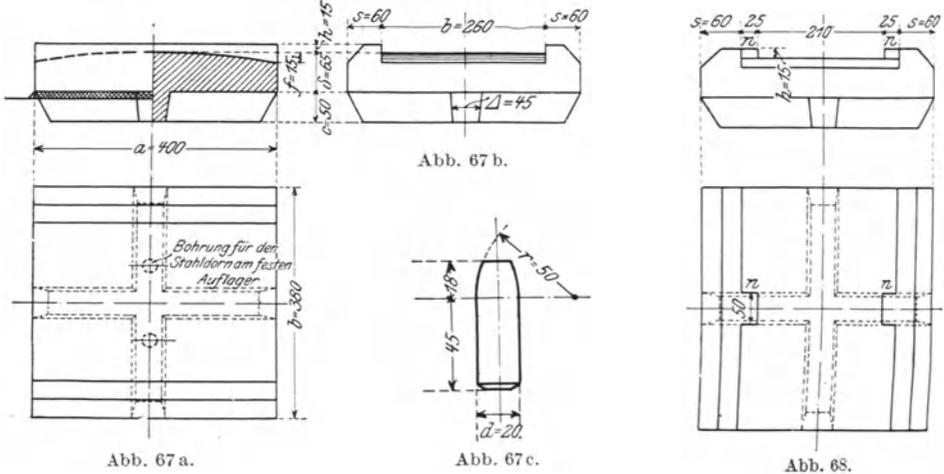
und 68. Auflagerplatten aus Gußeisen.
